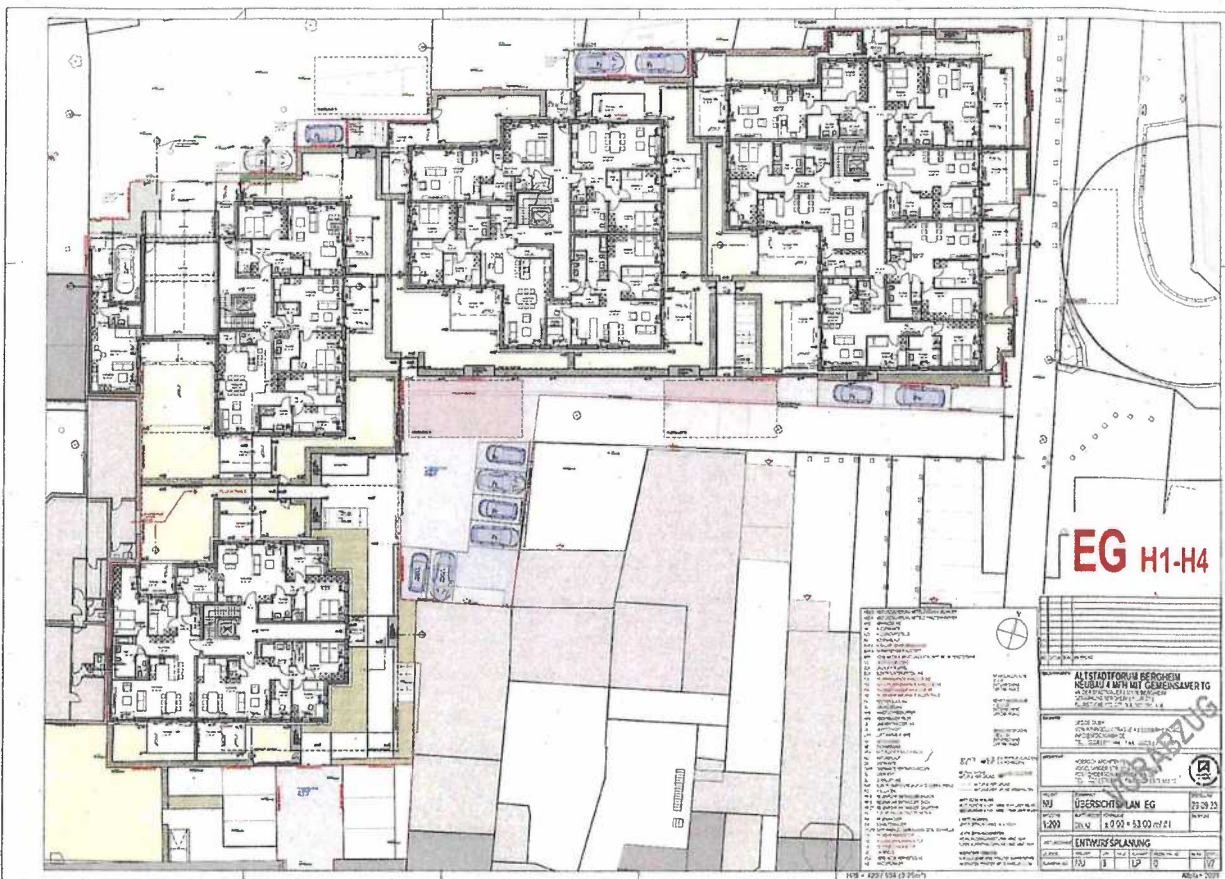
Grundriss des geplanten Vorhaben
